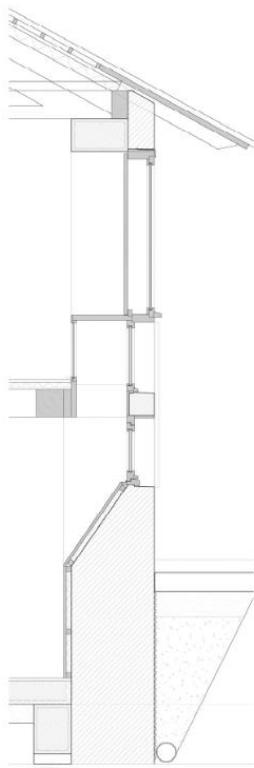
Sección constructiva [Congrés d'Arquitectura 2016]
